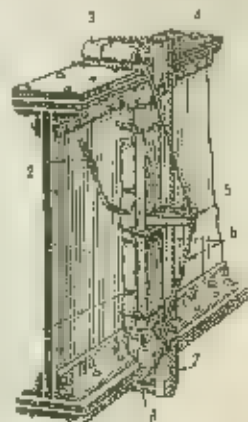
Расположение зарядов надальной фермы на балках железнодорожного моста
